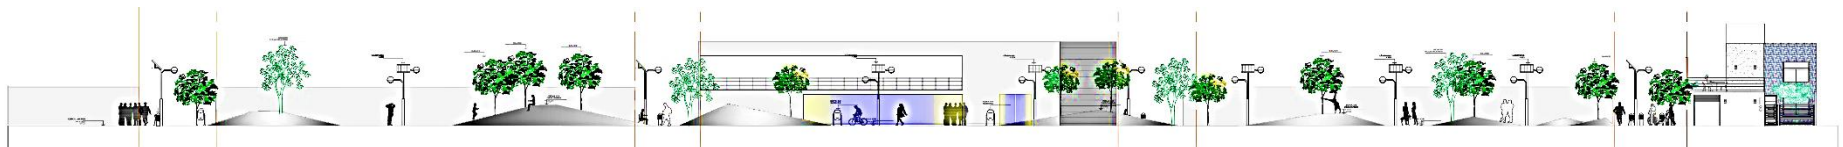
Alzado de la plaza principal [Corte "B"]. Plano de elaboración propia, 2017.
